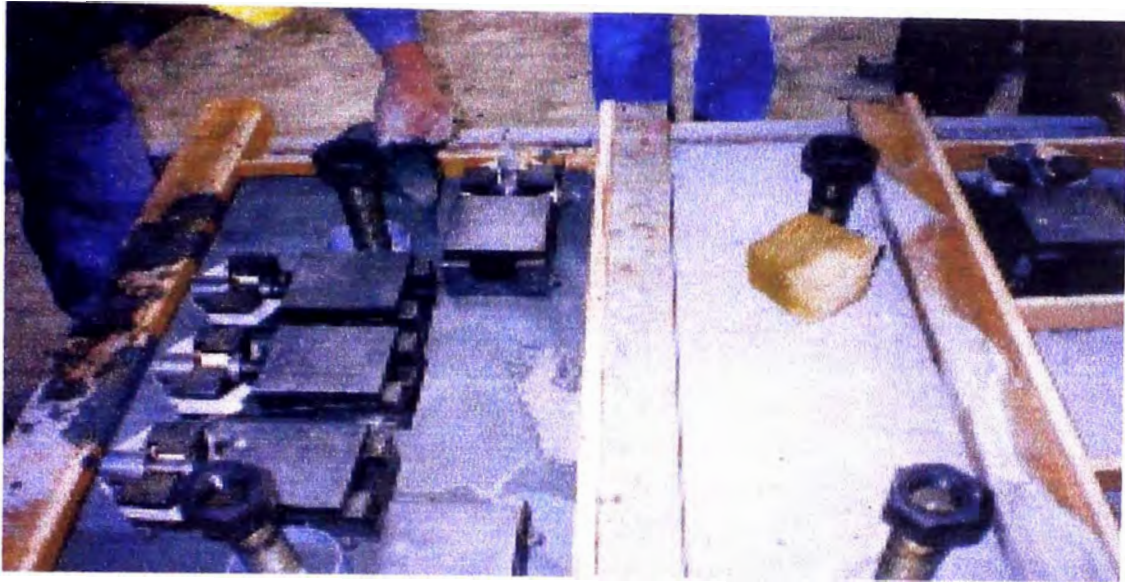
La plantilla metálica durante el proceso de vaciado de concreto, luego será retirada y los pernos de anclaje quedarán fijos al concreto.
